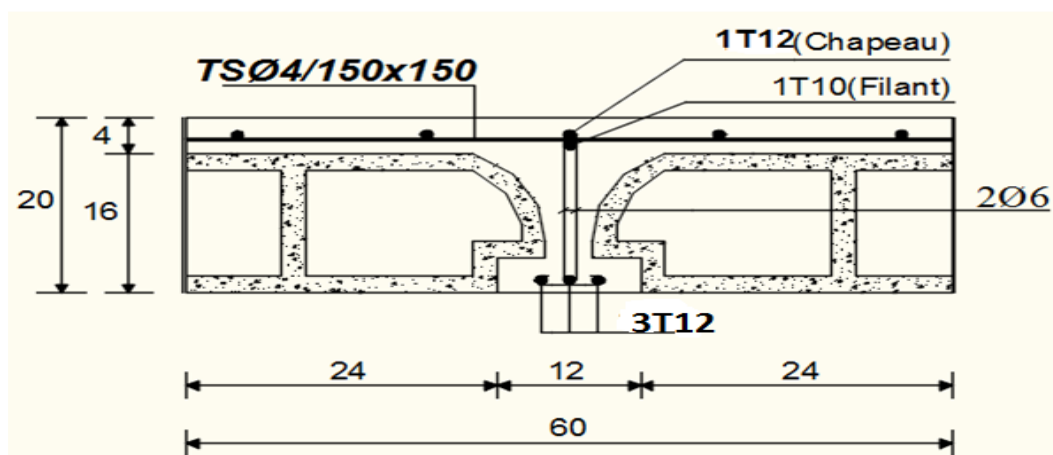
Coupe transversale d'un plancher à corps creux.
